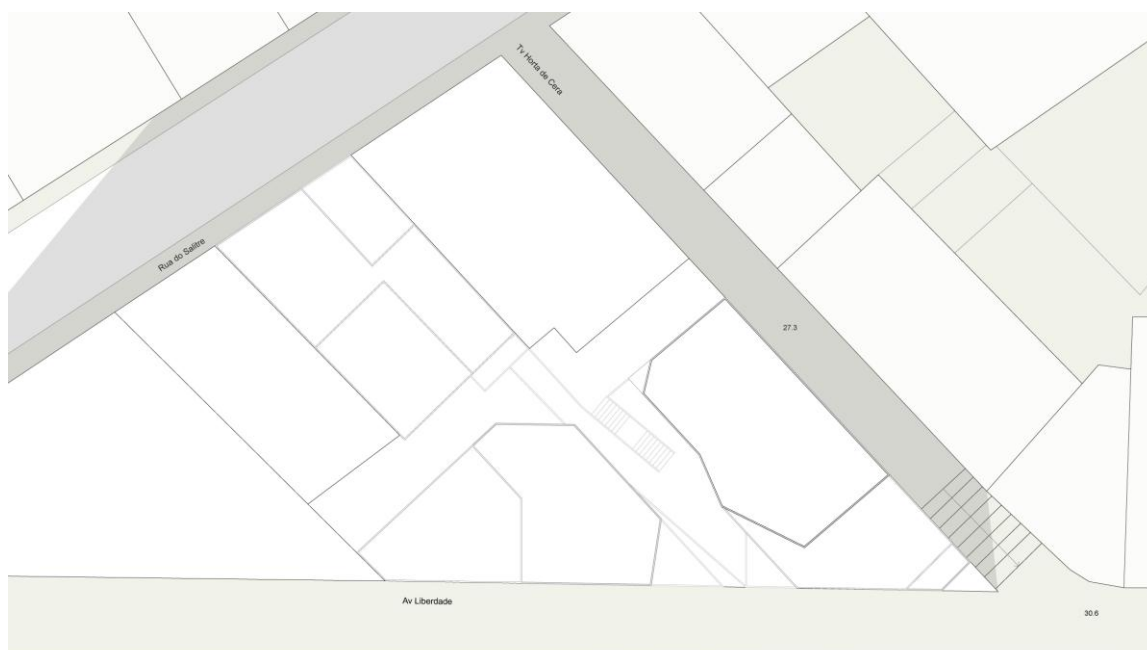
Planta de Cobertura. (Ilustração nossa, 2013)
